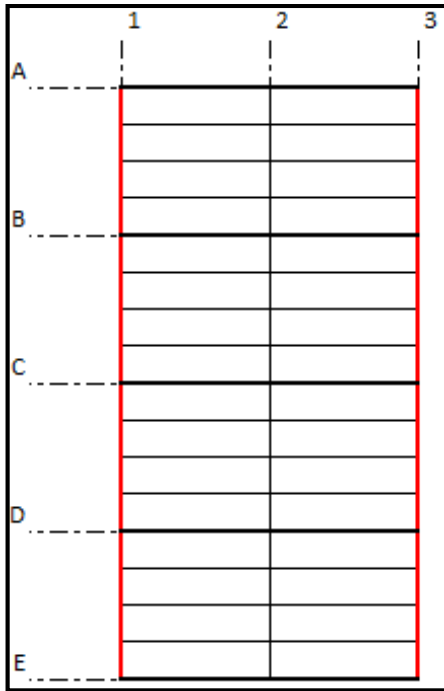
Vigas principales perimetrales en el eje "Y".
